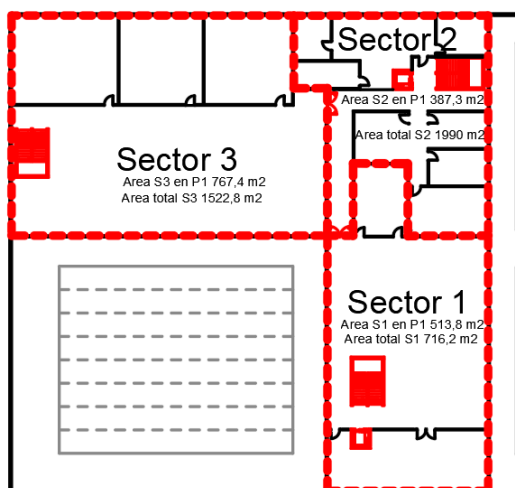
Sectorización primera planta (P1) y superficie de los sectores.
